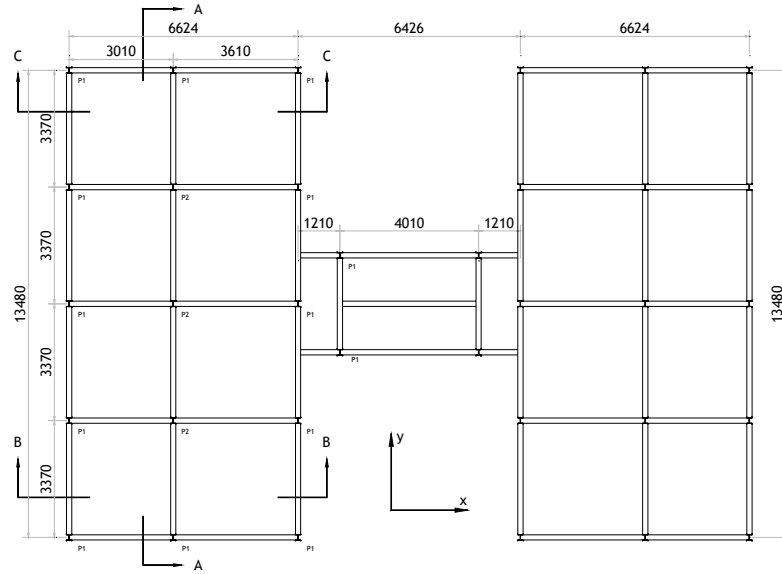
Pavimento tipo indicando as posições dos pilares e vigas (medidas em mm).
